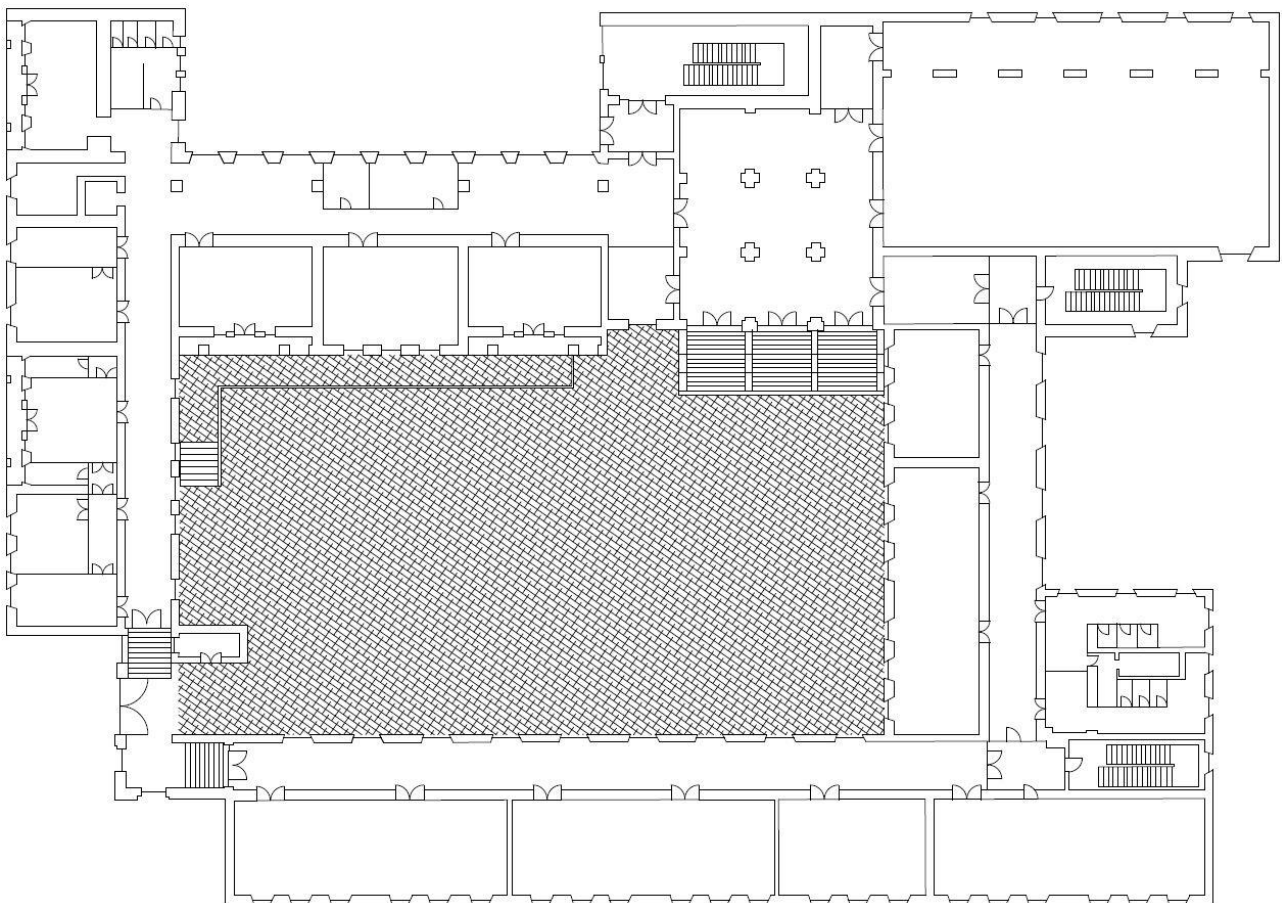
Planimetria generale dell'ex Istituto Niccolò Tommaseo con messa in evidenza della planimetria della corte interna.
